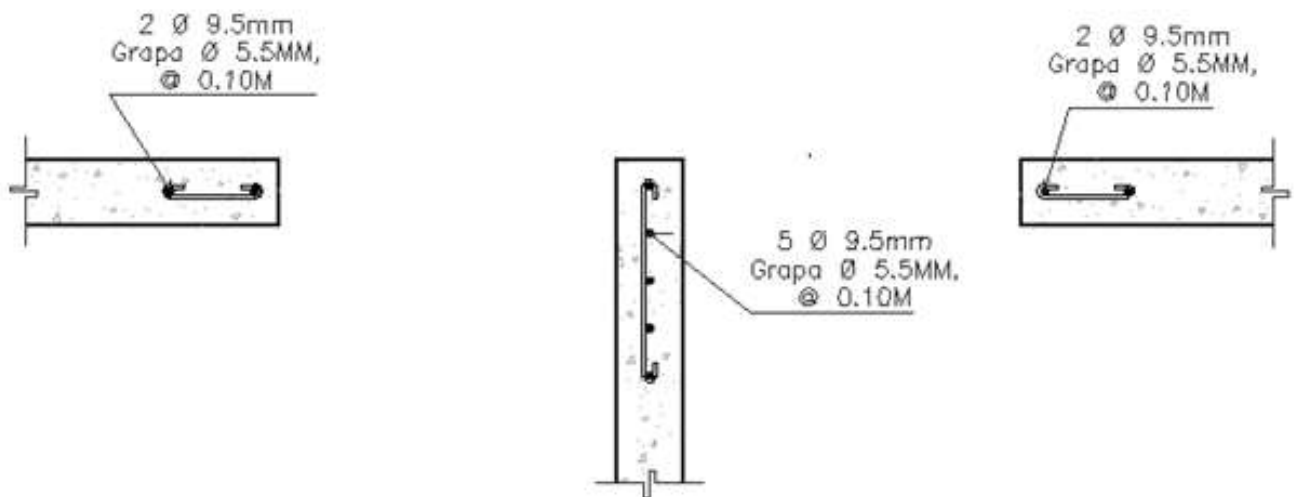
h Detalle típico de refuerzo vertical en hueco de puertas
